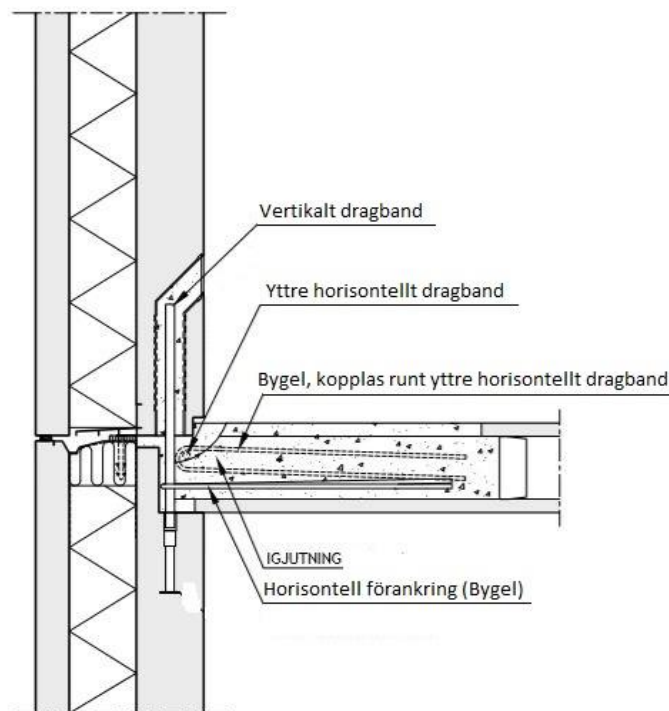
Utformning av koppling mellan bärande vägg och HDF-bjälklag (Betong Elementforeningen, 2018).
